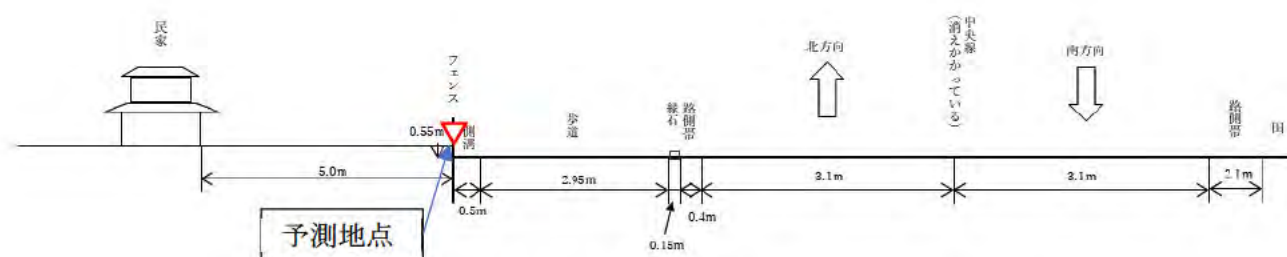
騒音予測地点b近傍の道路断面図
